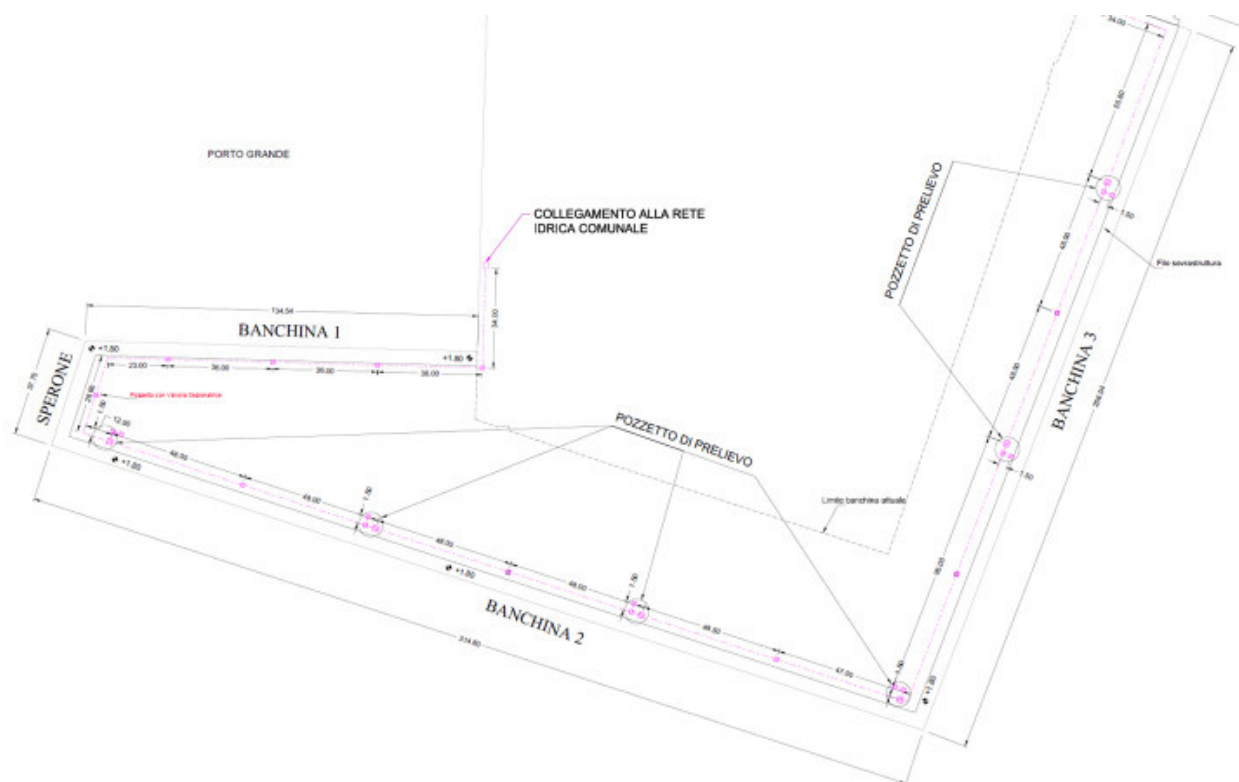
Stralcio planimetria EEG10016T2371- Banchina 2 e 3
